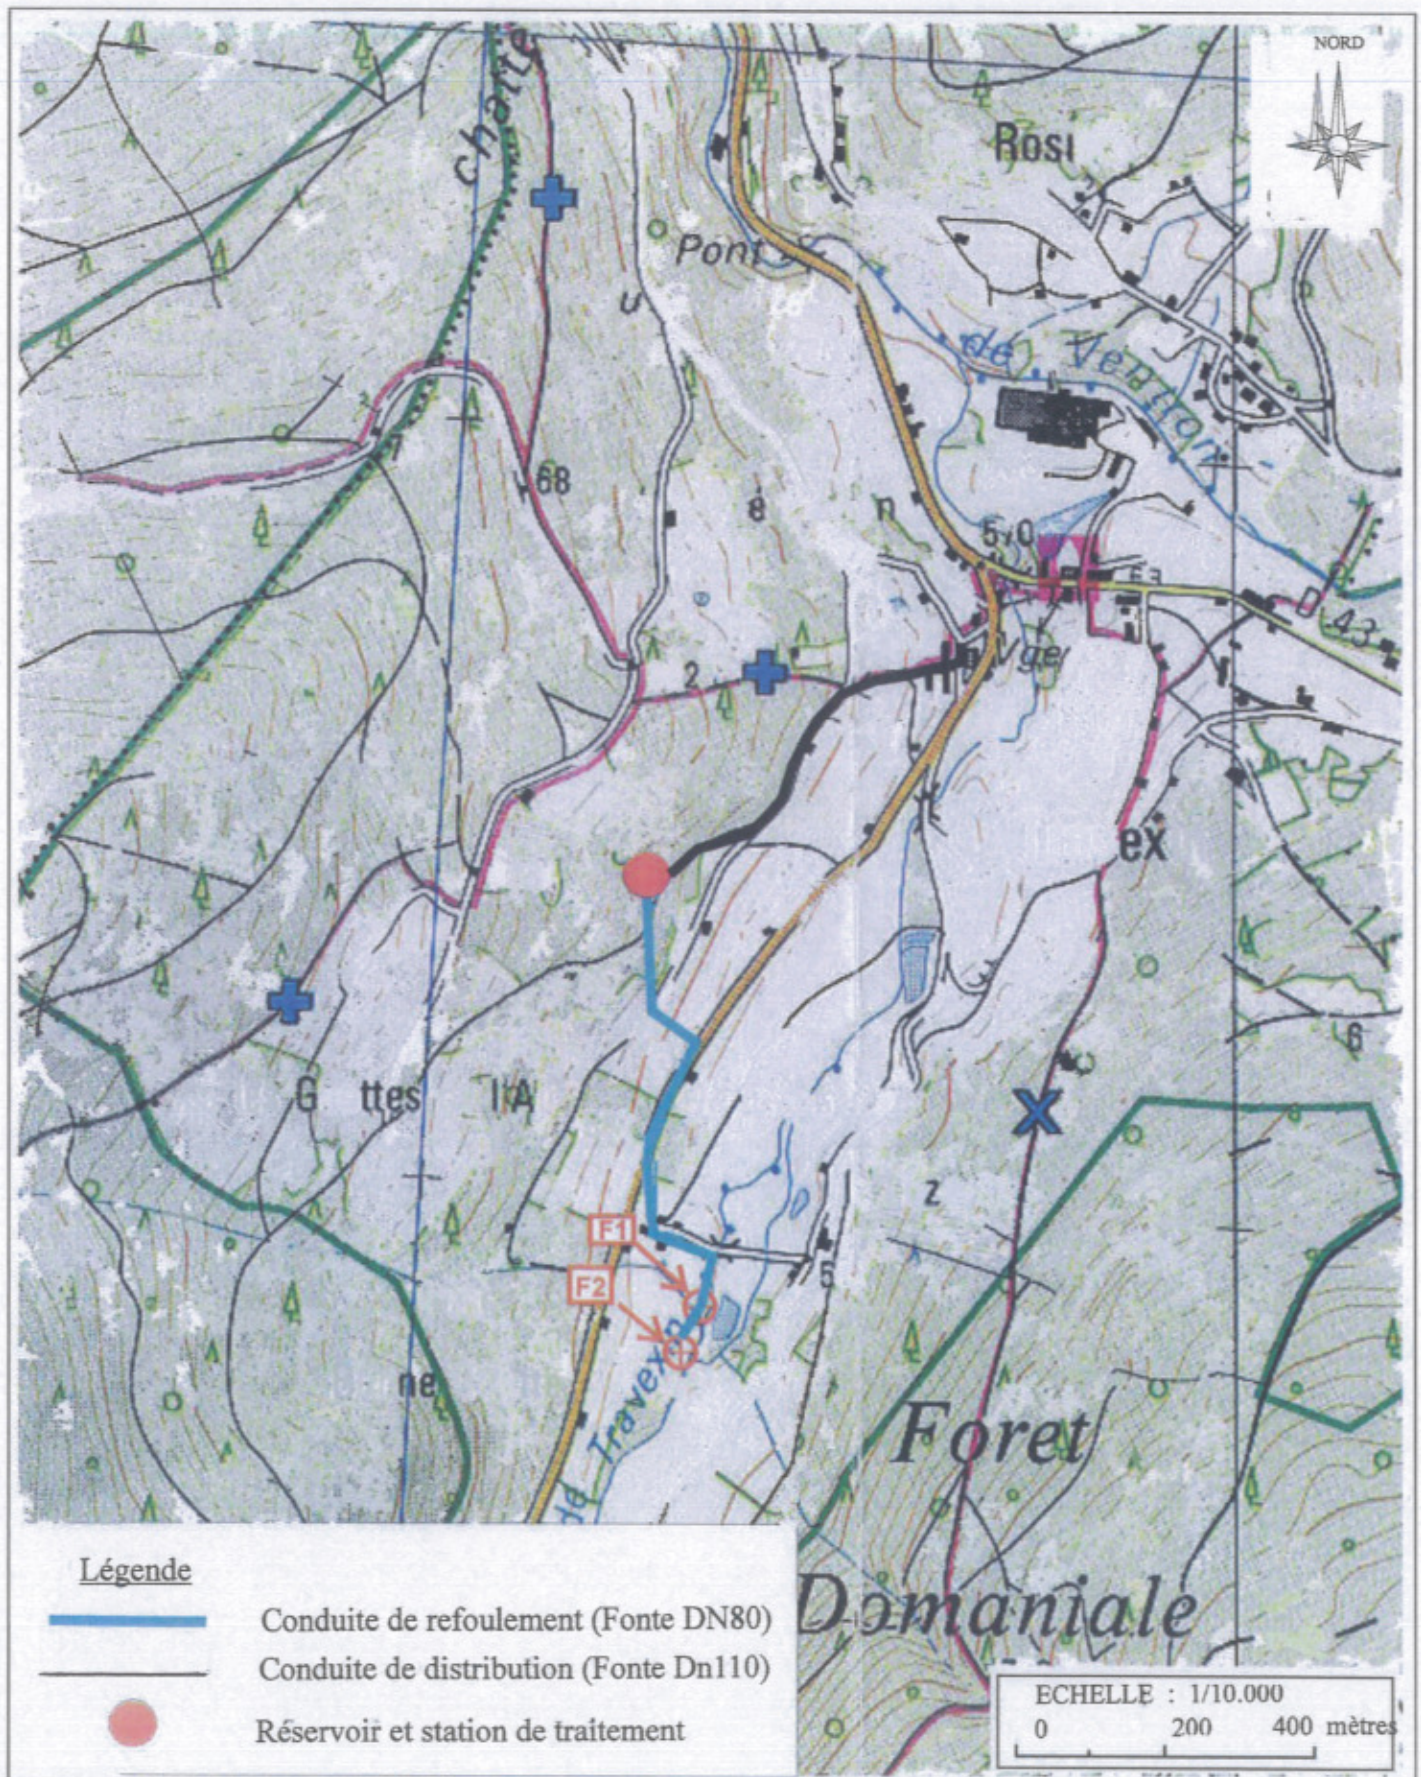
Tracé de la conduite de refoulement, du nouveau réservoir et de la conduite de distribution gravitaire
